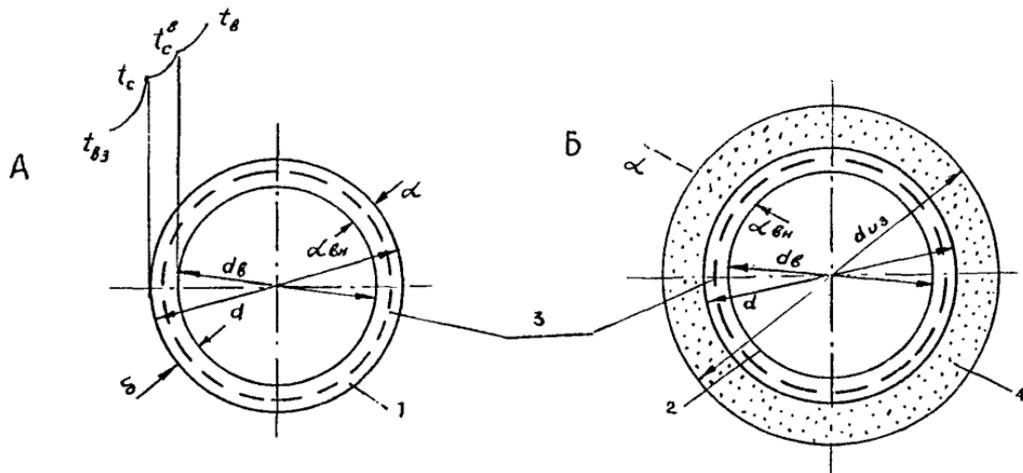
Схема металлополимерной трубы для расчета теплопередачи через цилиндрическую стенку:
